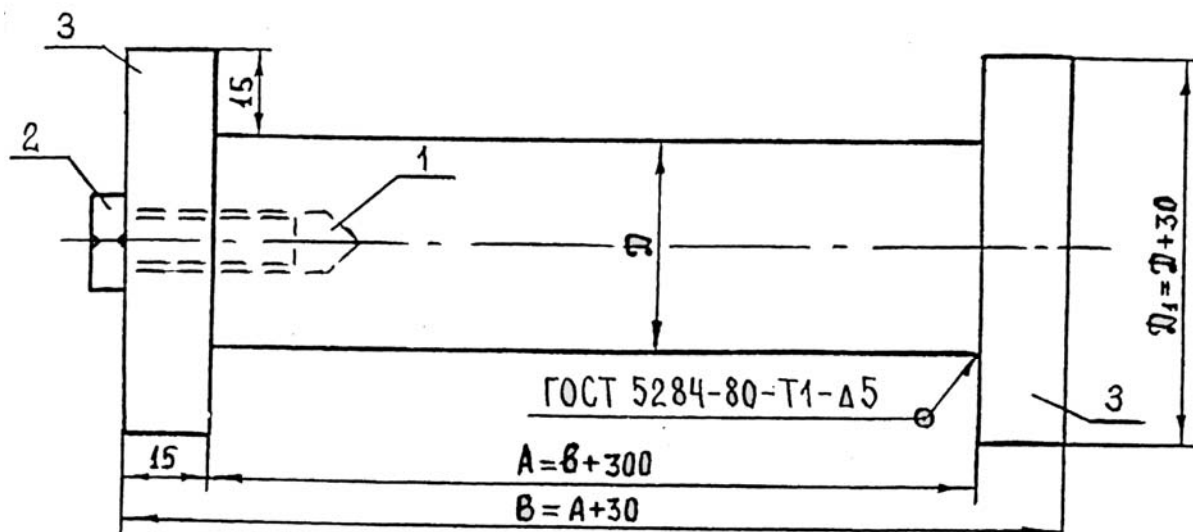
Отгибающее устройство для усиления балки четырьмя пучками из одиночных арматурных канатов класса К-7: 1 - отверстие с резьбой М10 под болт диаметром 10 мм; 2 - болт диаметром 10 мм с резьбой М10; 3 - ограничитель (с одной стороны отгибающего крепится с помощью болта по поз. 2, а с другой – с помощью сварки); диаметр (Д) принимается равным 78 или 80 мм соответственно при сверлении в стенке балки отверстий диаметром 80 или 82 мм; в - ширина стенки балки в месте установки упора; материал - сталь; масса одного устройства для усиления балок по выпуску 56 Союздорпроекта равна 16,8 кг. Размеры даны в миллиметрах
